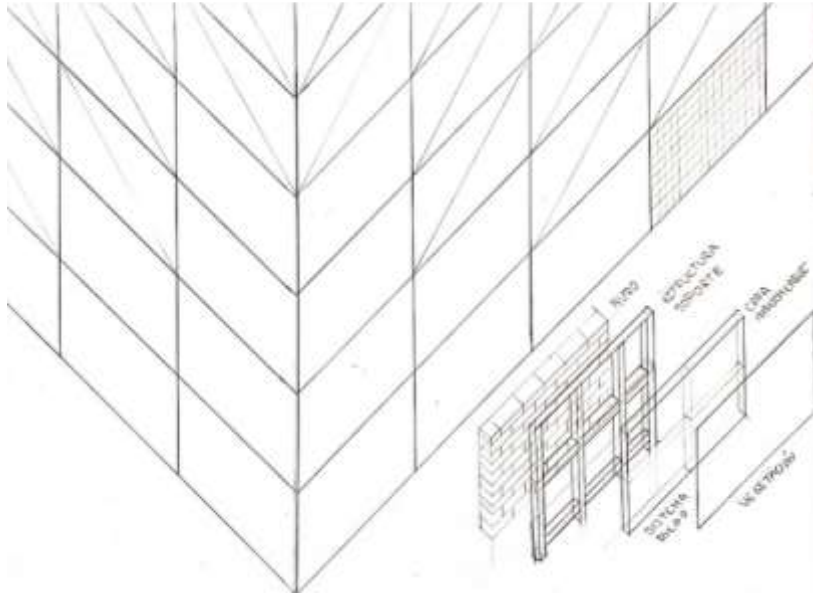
Boceto de fachada plana. Fuente: Elaboración propia.
